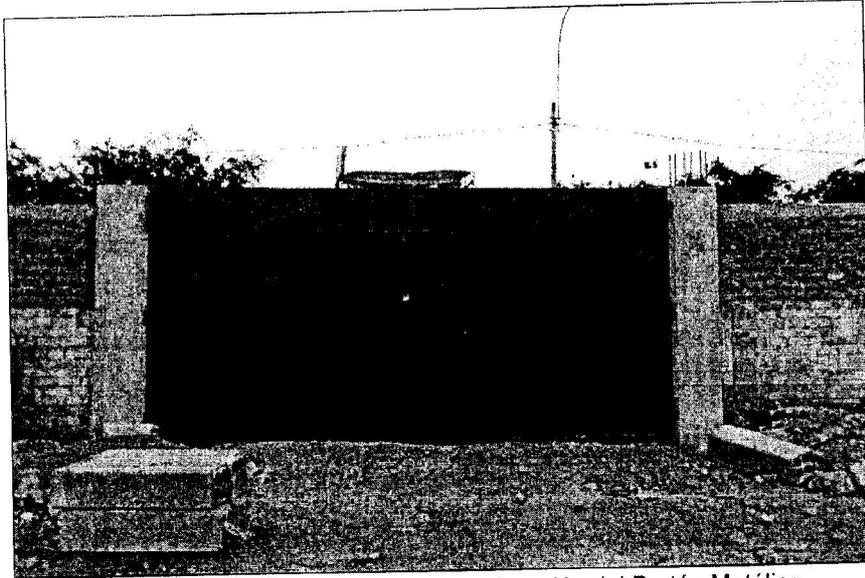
Trabajo terminado de la colocación del Portón Metálico.
